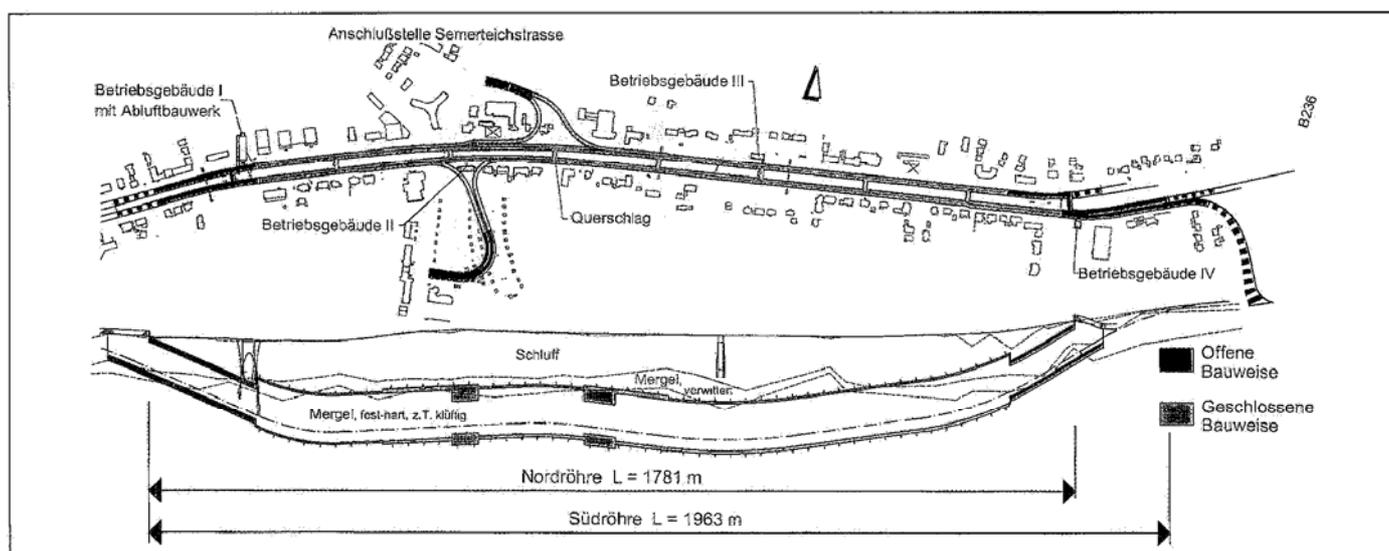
Bauwerksdarstellung (Lageplan/Längsschnitt)
